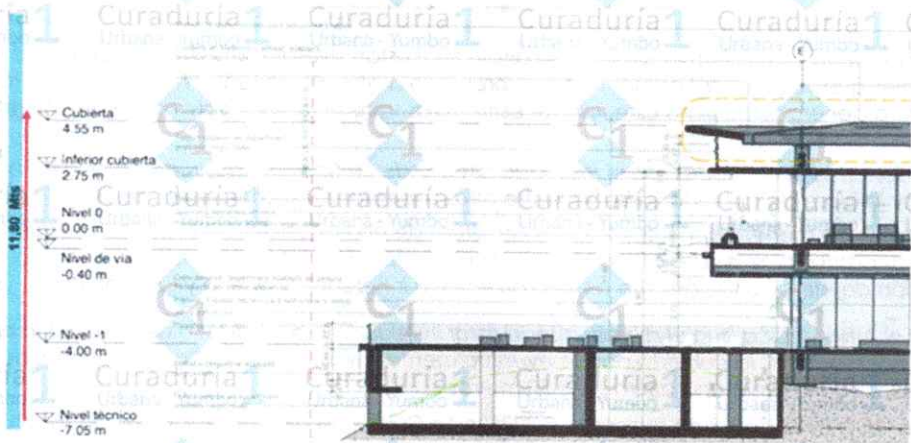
Detalle Sección,medidas totales edificación actual modificación. Fuente: propietario del predio.
